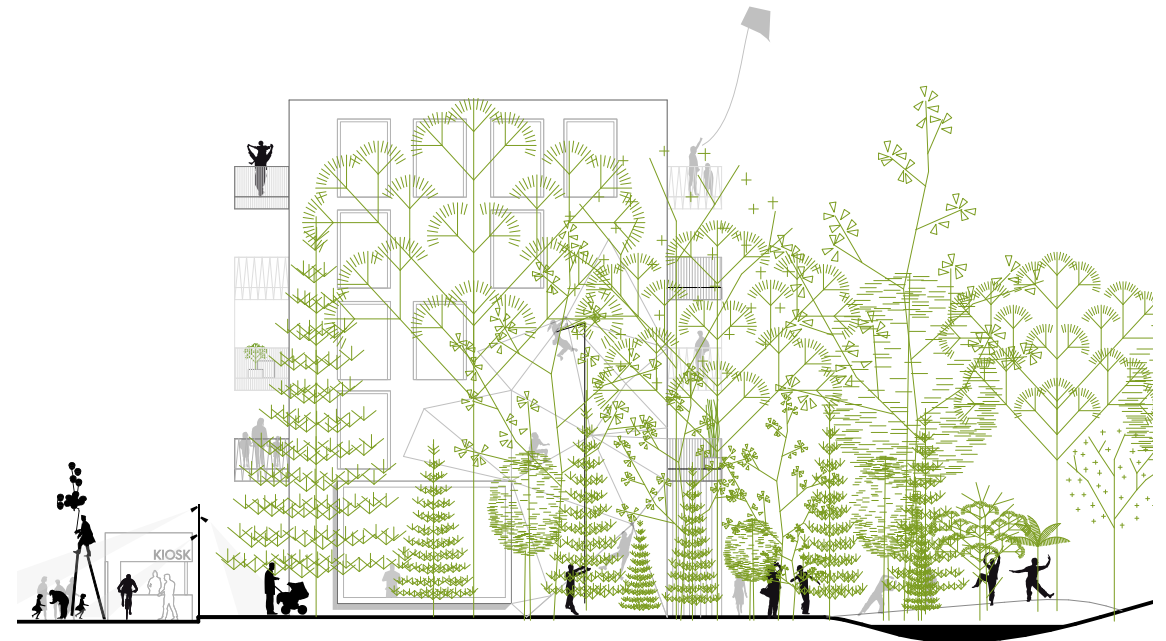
Grundriss und Schnitt Cuts, 1:250
